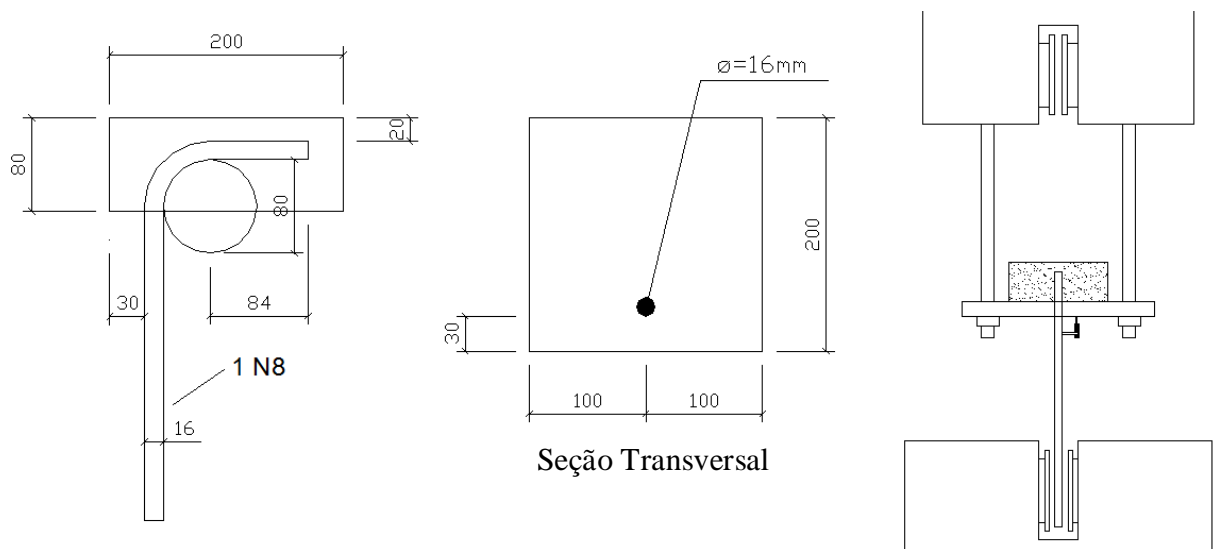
Formas do modelo de arrancamento com barras de 16 mm com gancho (dimensões em mm)
